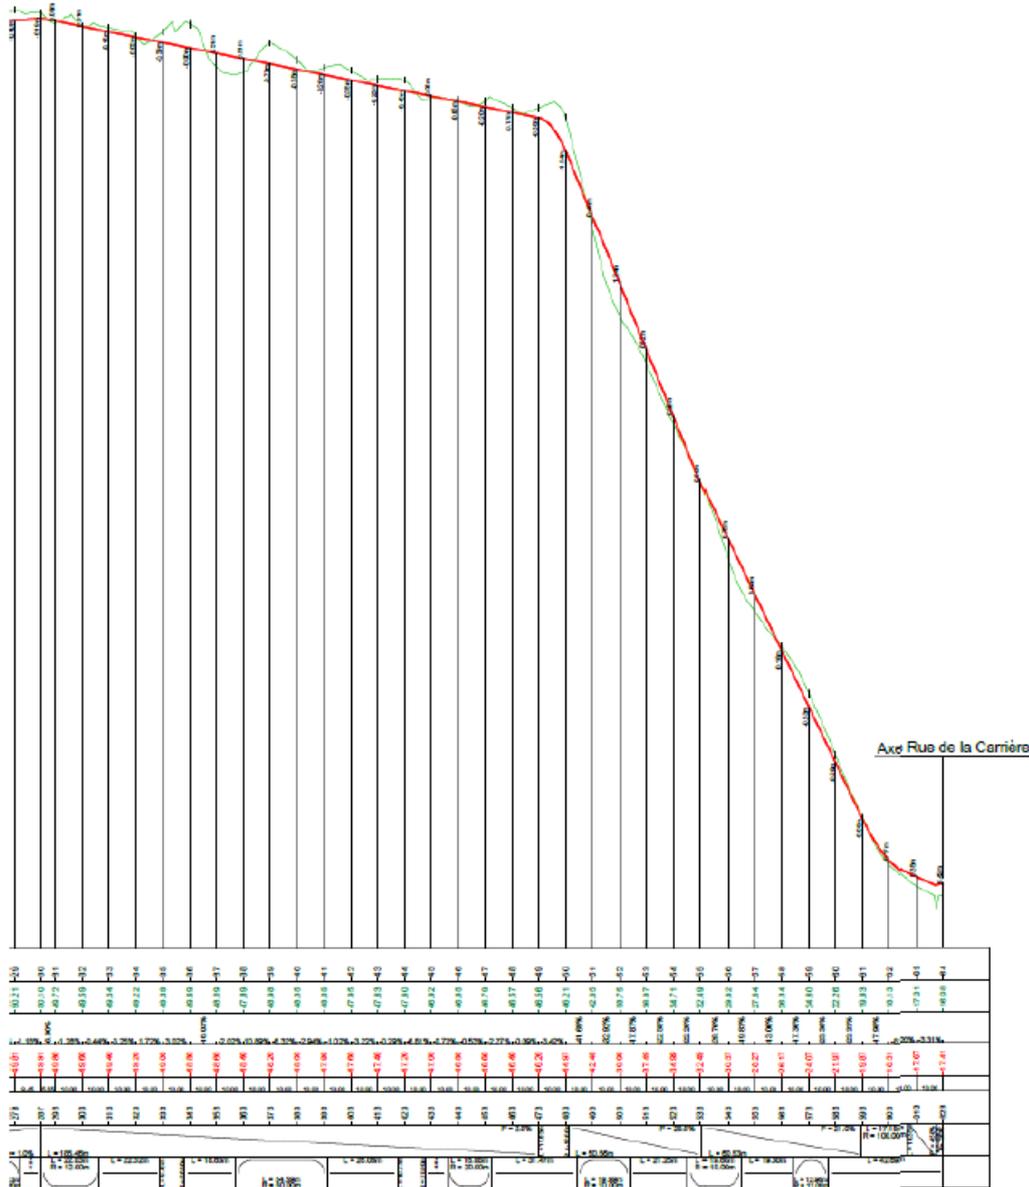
Profil en long de la rue des coteaux -secteur 1
